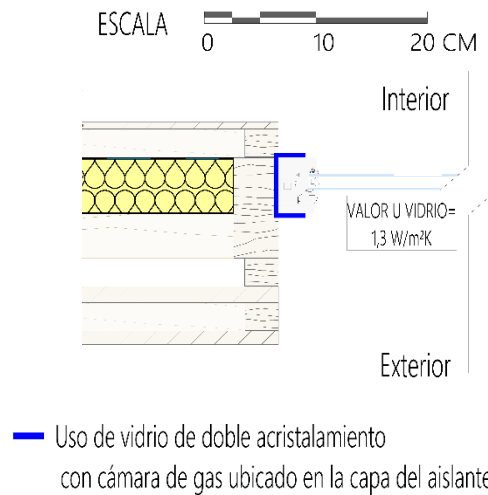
Localización de carpintería en capa de aislamiento (vista en corte).
